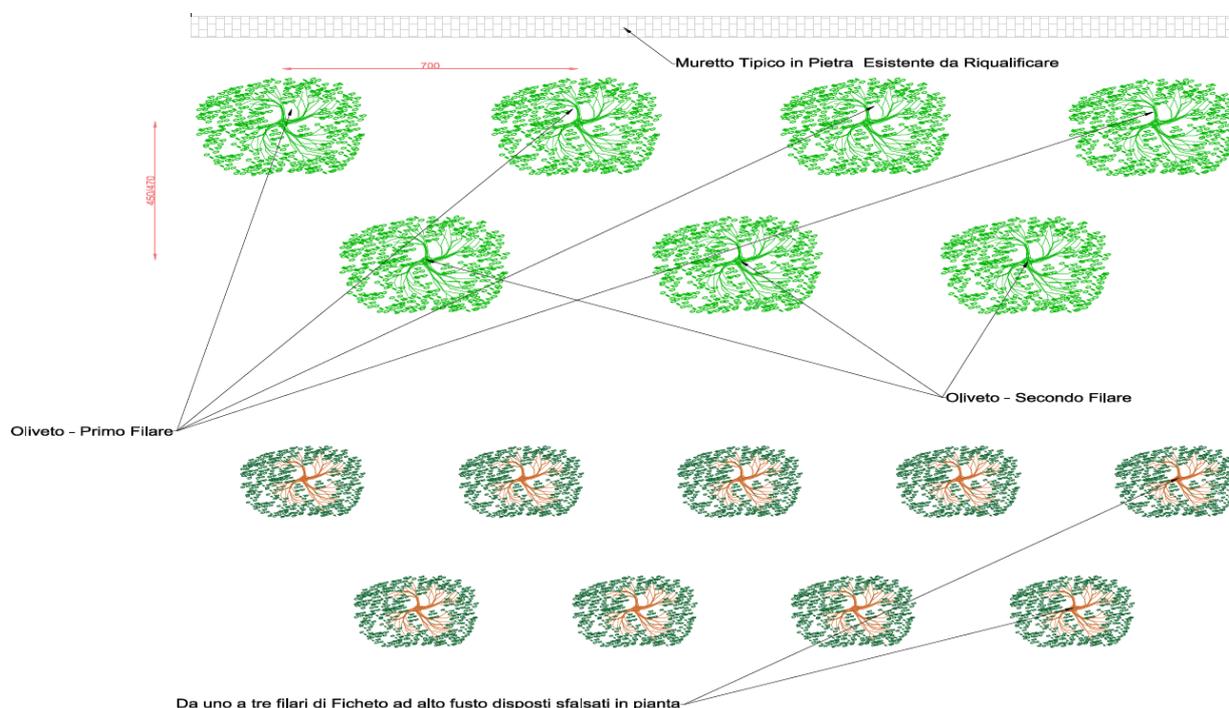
Planimetria esplicativa della distribuzione delle piante all'interno della fascia perimetrale
